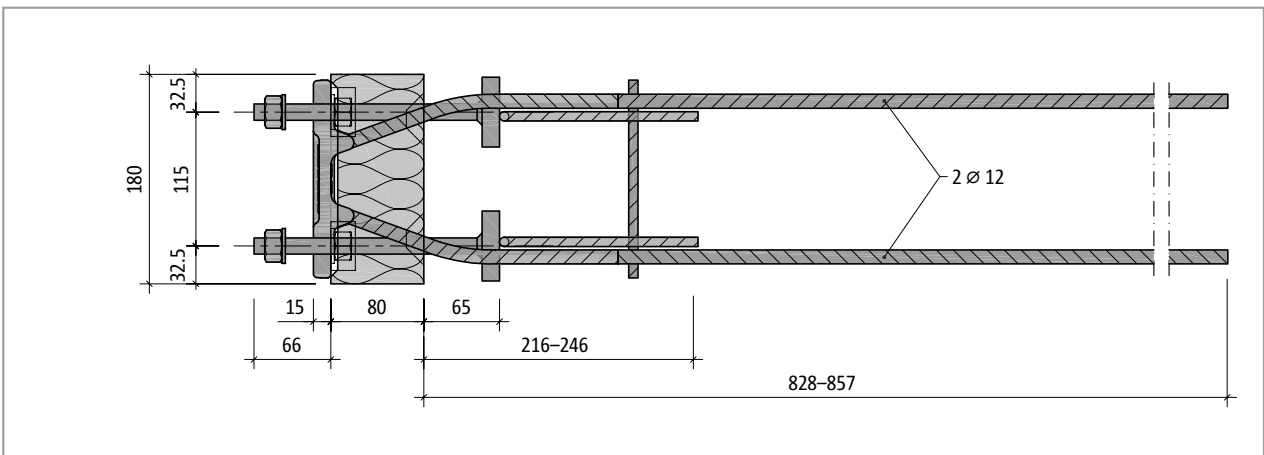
Schöck Isokorb® T type SQ-V3: Plan view
